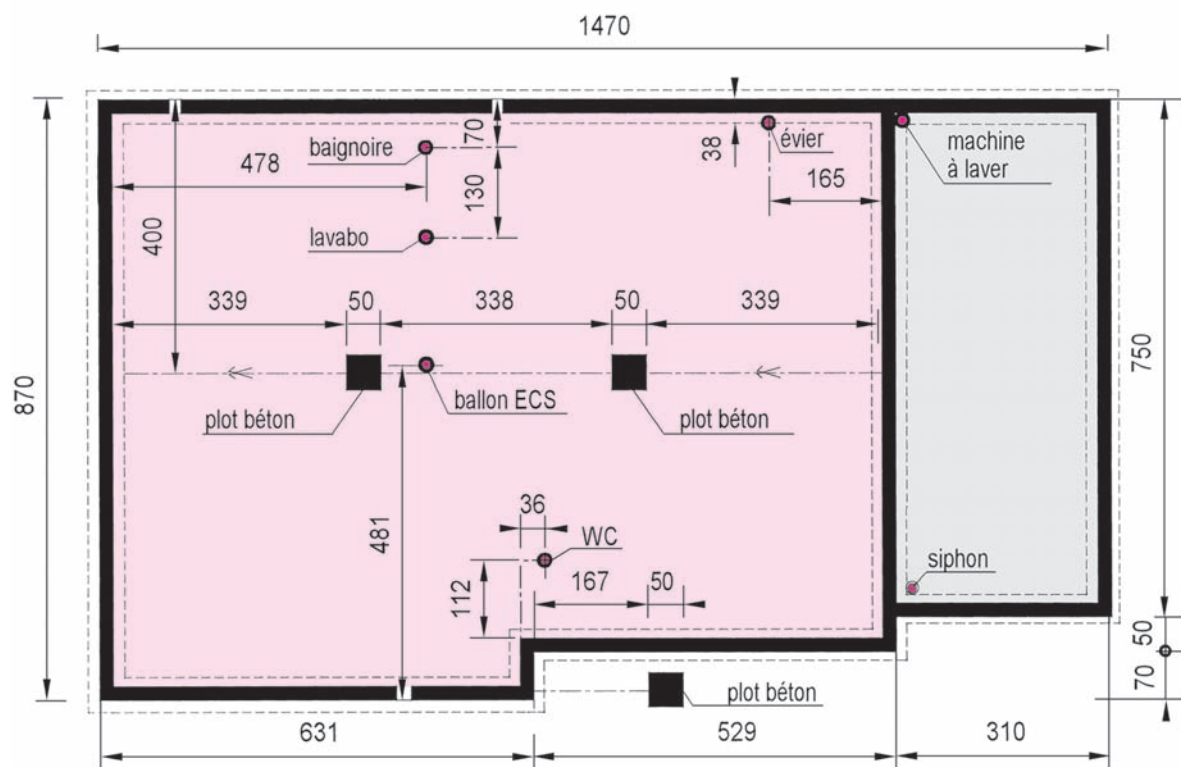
Plan de fondations par semelle et repérage des évacuations EU-EV
